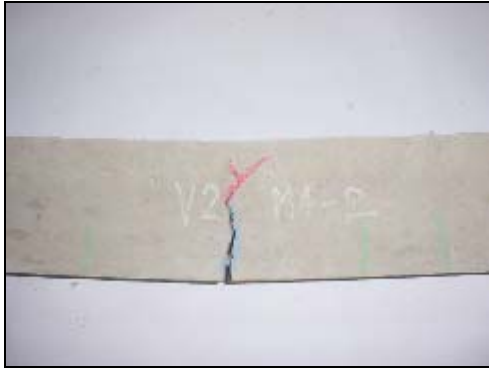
3 Grietas viga 1 modelo 1
